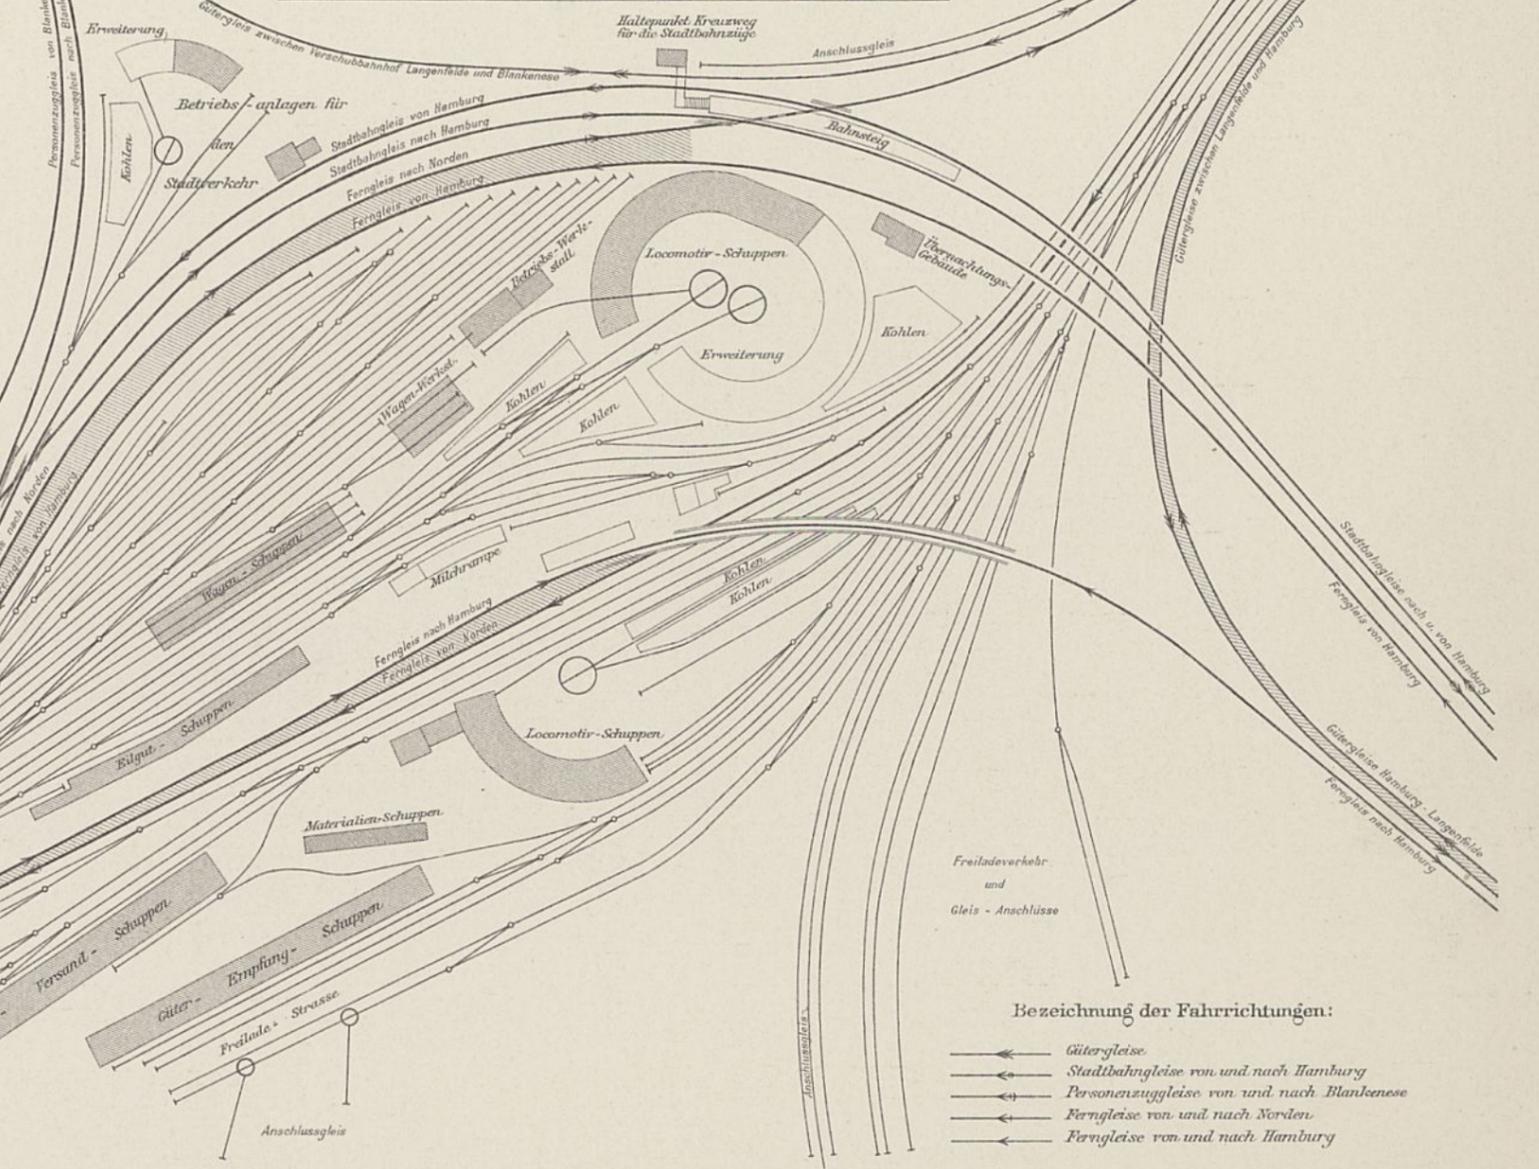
Lageplan des Hauptbahnhofes in Altona.
